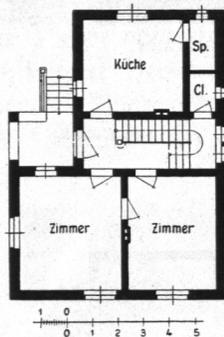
Haltestelle Dhlsdorf, Wohngebäude, Grundriß.
